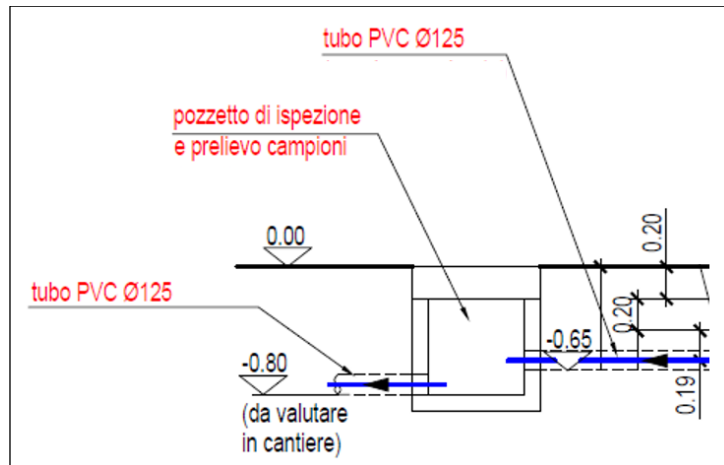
Installazione del pozzetto fiscale di campionamento prevista a progetto.
